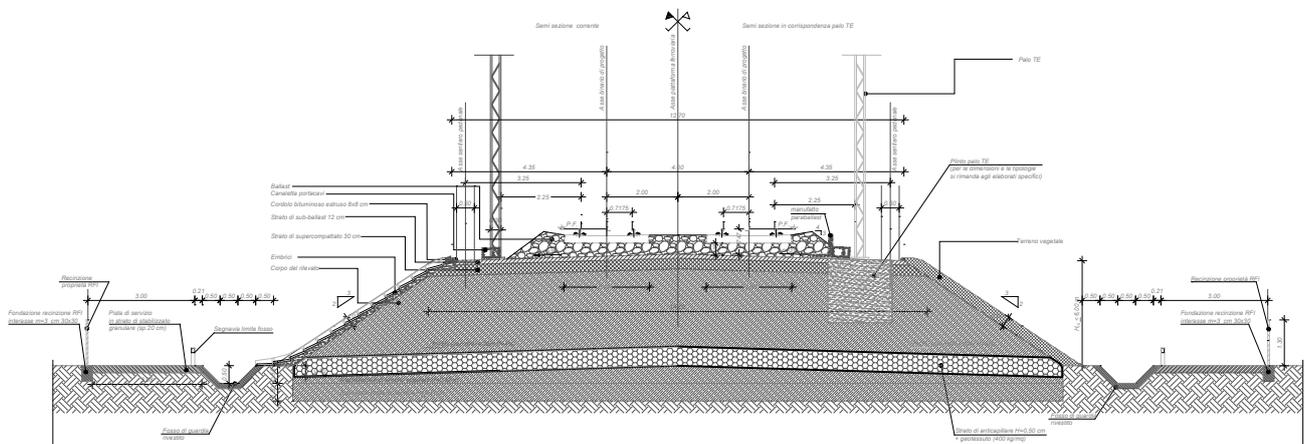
Sezione tipo ferroviaria in rilevato a doppio binario (piattaforma in retto) con  $H_{ril} \leq 6,00$  m
